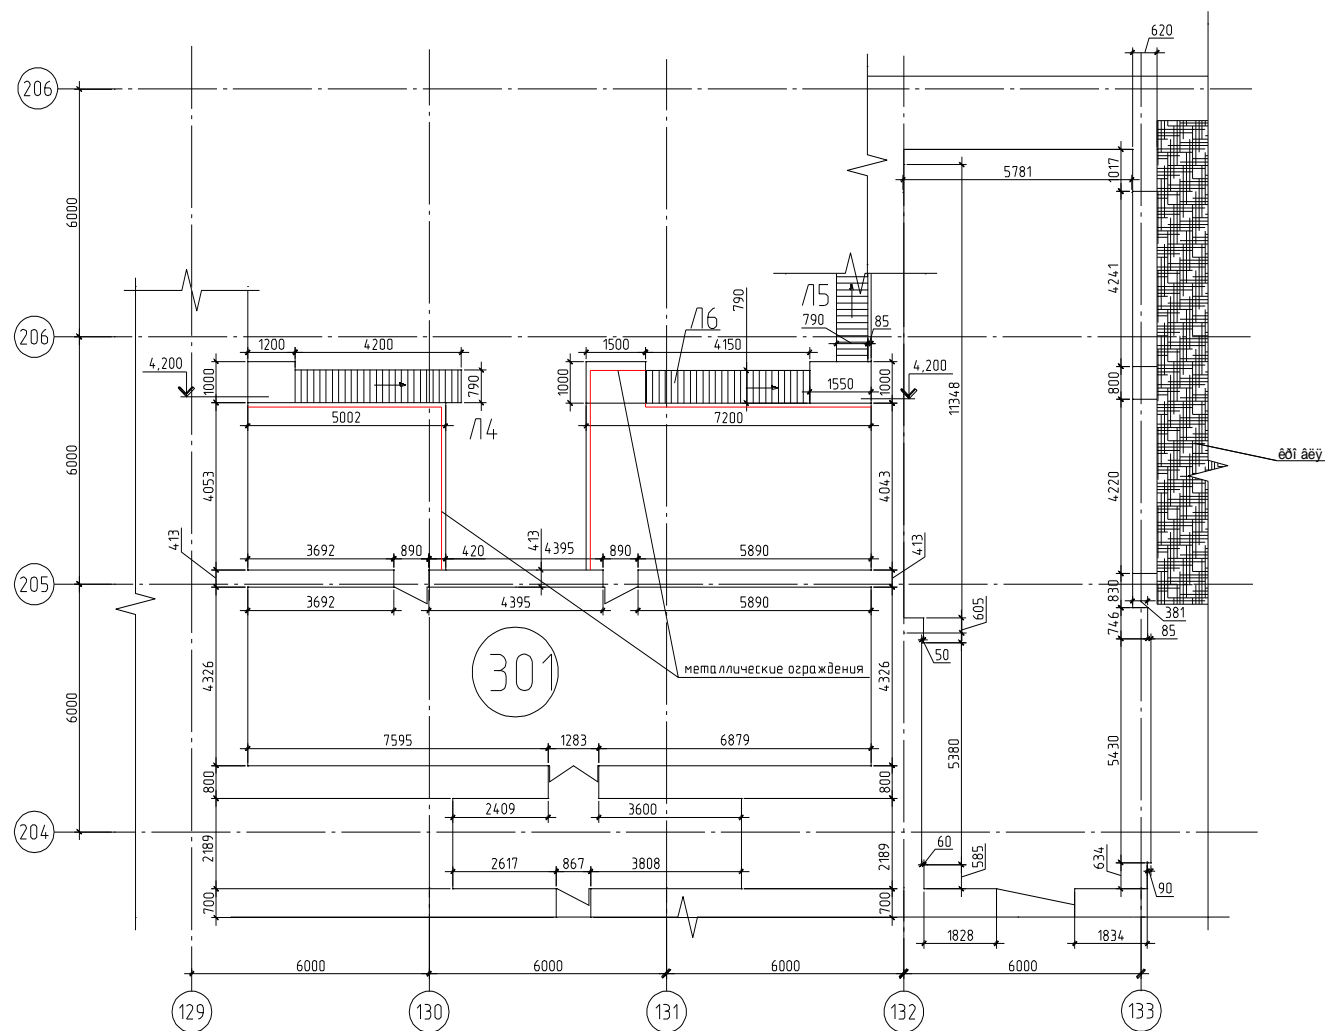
План 3-го этажа в осях «204-206/129-132» на отм.8.450
